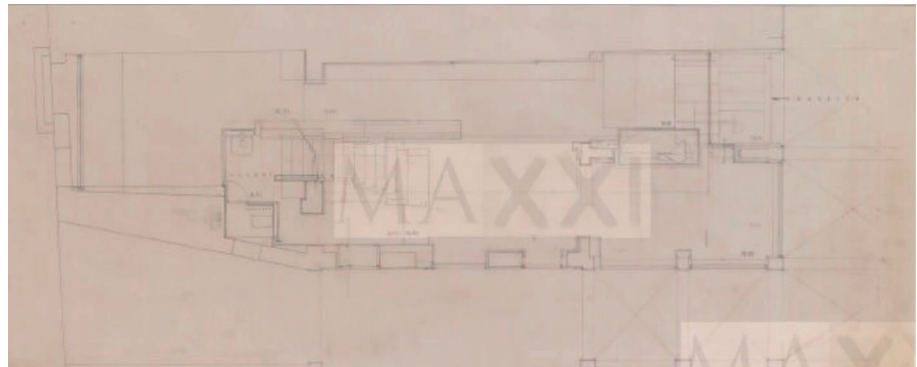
Tienda Olivetti. Croquis de la planta baja
